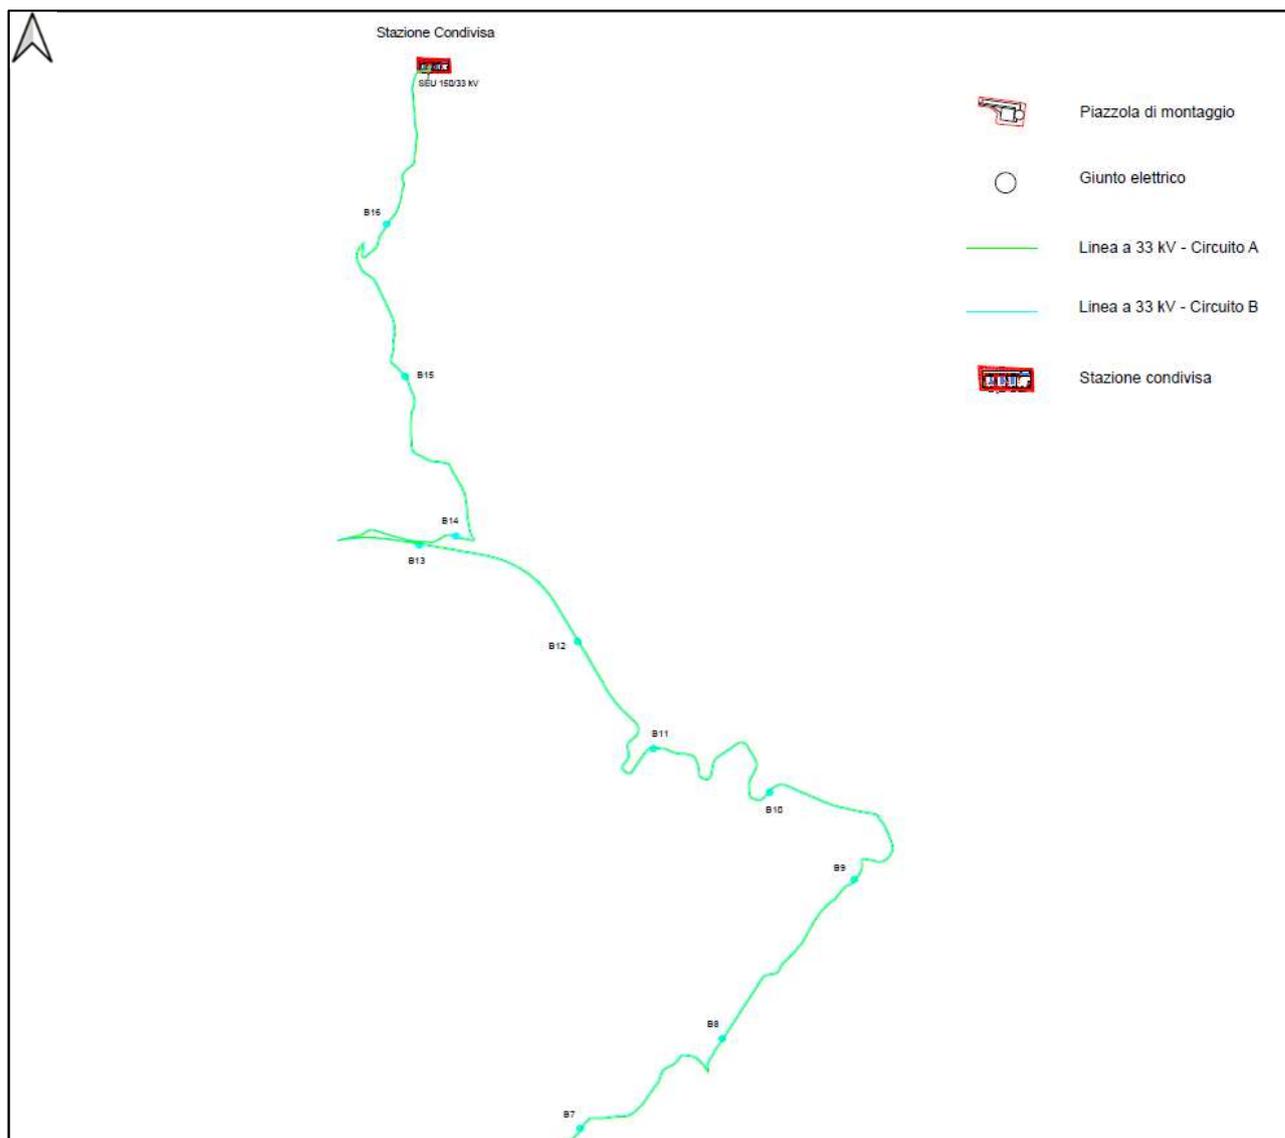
Planimetria di distribuzione linee MT di collegamento tra i circuiti e la SEU 150/33 kV di Aliano
